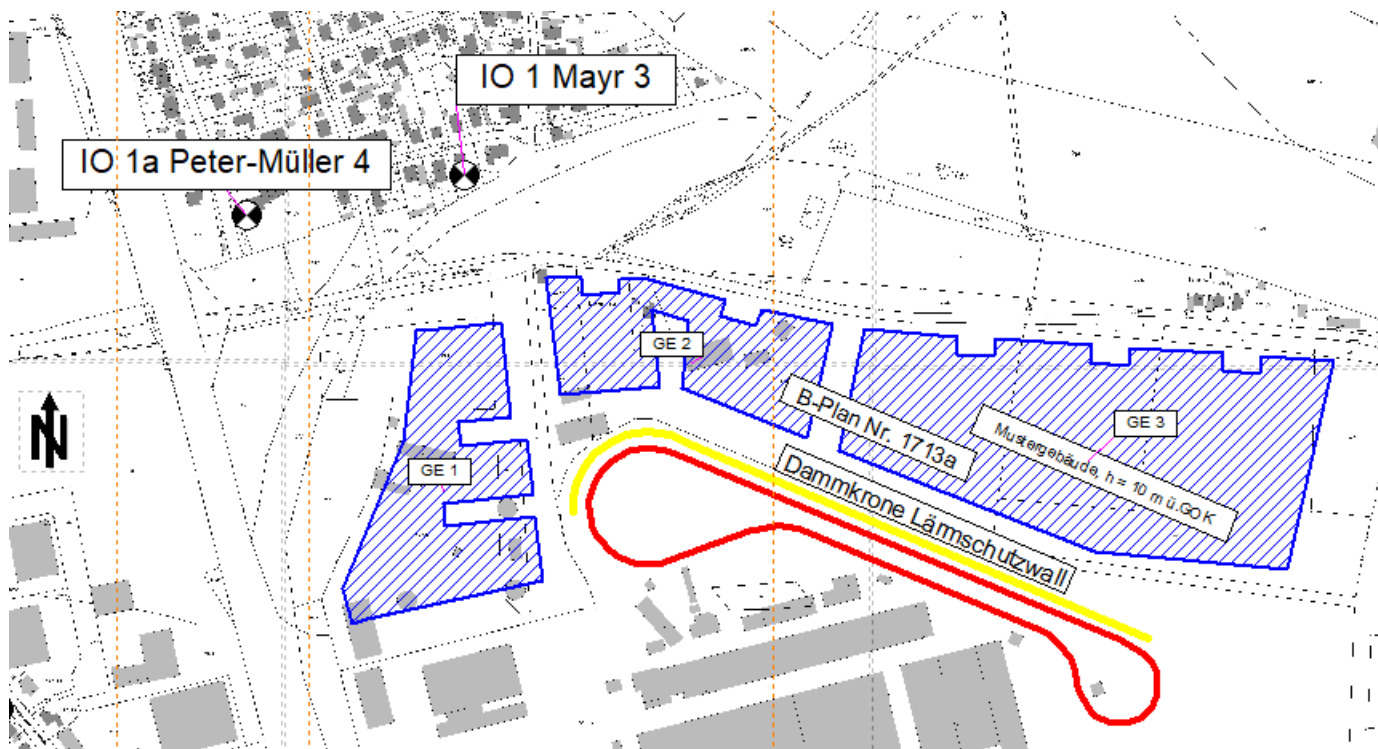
Lageplanskizze KMW mit Mustergebäuden aus den Baugrenzen des Planteils zum B-Plan 1713a als Riegelbebauung und Lageausrichtung des Lärmschutzwalls im Hinblick auf die Immissionsorte im Nordwesten.
